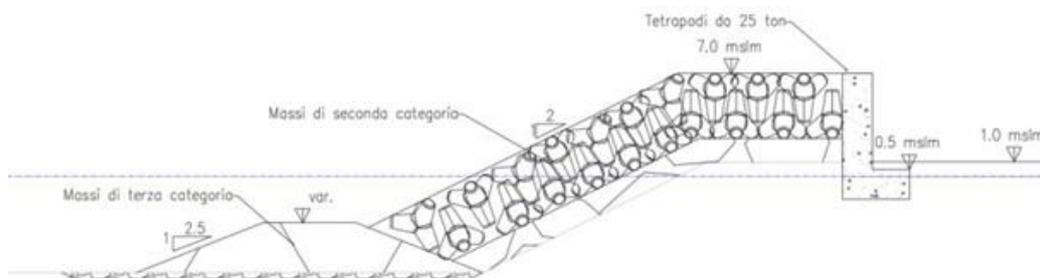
Sezione tipologica dell'area del faro (Sez.K)
